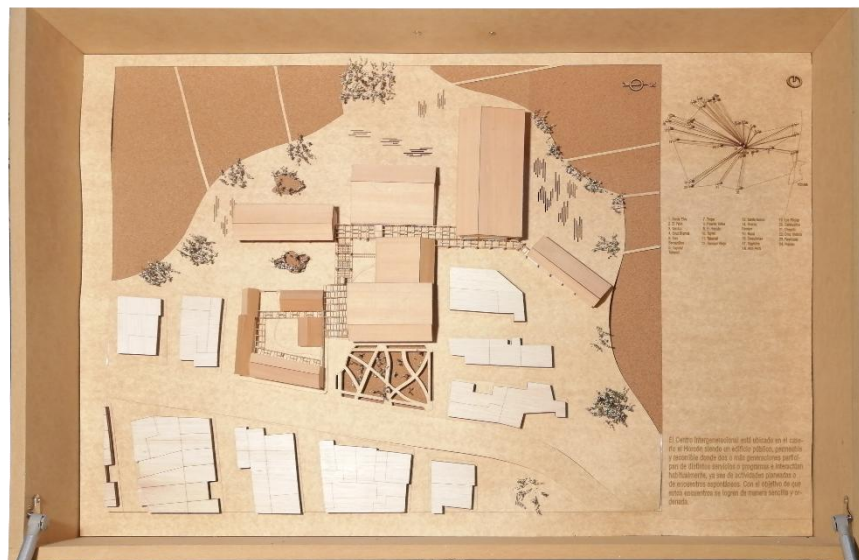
Maqueta Projectual Esc 1/250 Fuente: Propia
